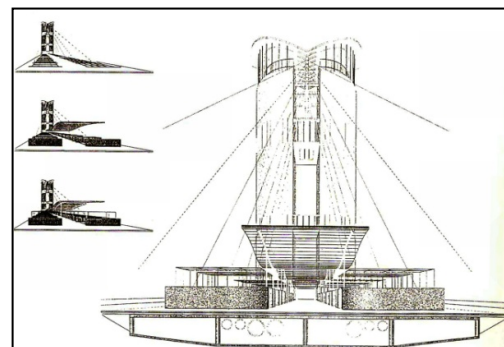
, Antoine Grumbach, *Garden Bridge*: desenho, 1996.
